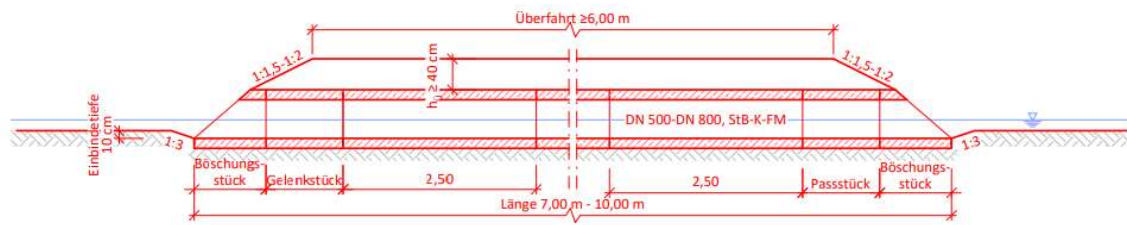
Längsschnitt der Teilverrohrung (Stahlbeton Rohrdurchlässe für niedrige Überdeckung)
